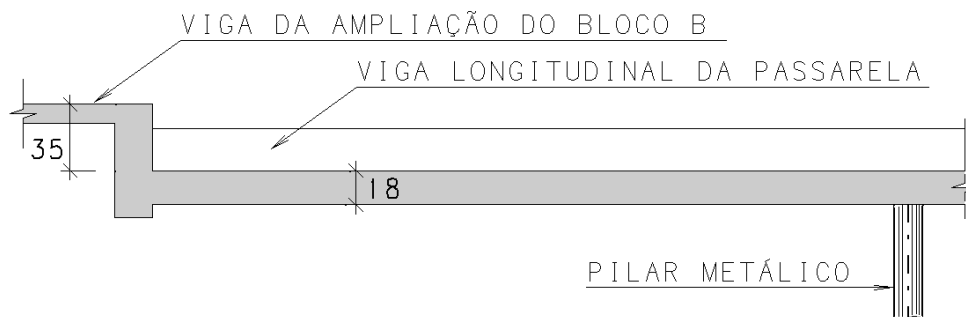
Corte Longitudinal e Ligação com a Passarela do Elevador
